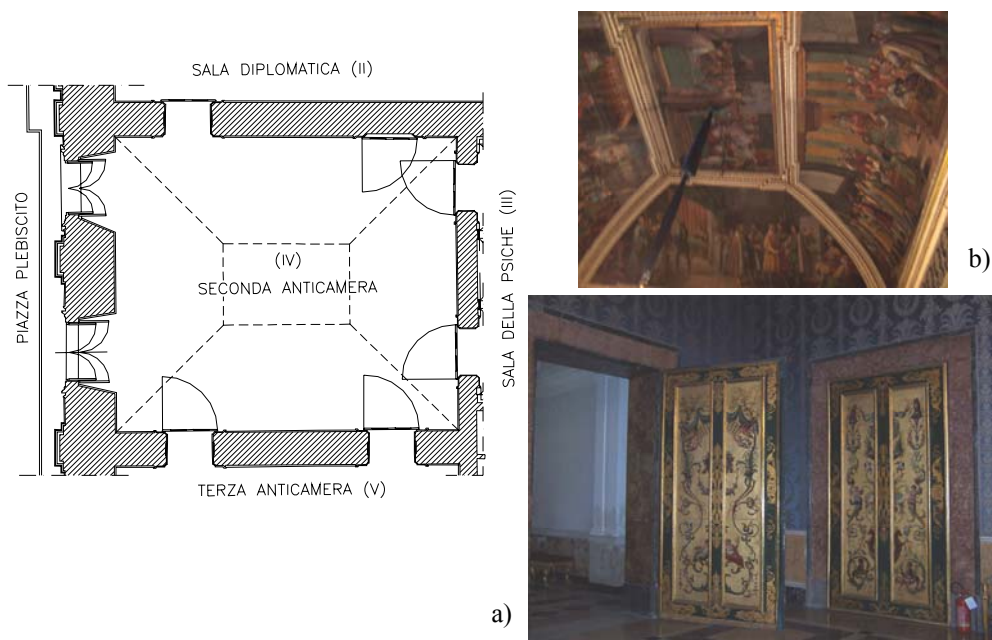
La Seconda Anticamera: a) pianta; b) viste interne.
